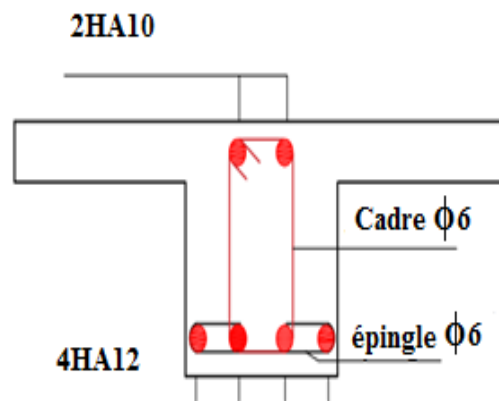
Schémas de ferrailage de la poutrelle isostatique ($b_0=20cm$).
